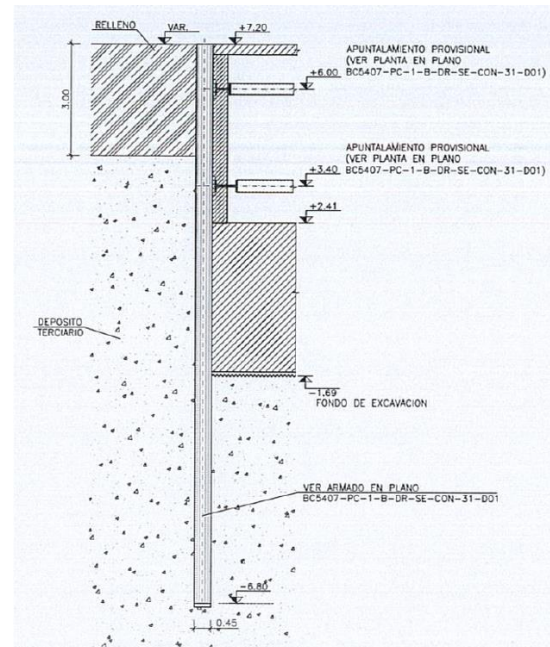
Esquema en alzado de los principales elementos de apuntalamiento
